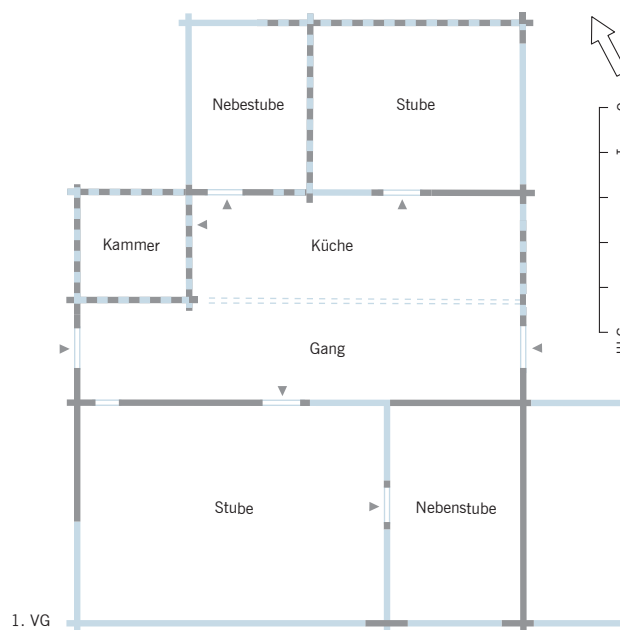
Rekonstruierter Grundriss des ersten Vollgeschosses von Haus Lauihof in Walchwil (Kat. 24), 1536d oder kurz danach.
